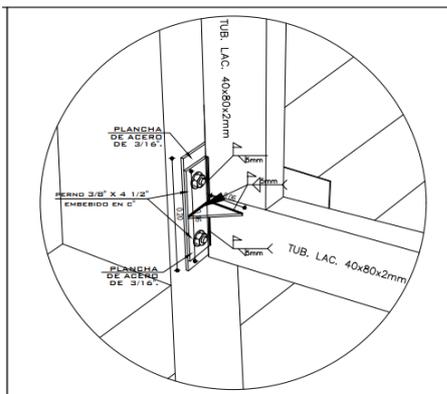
Detalle de anclaje de cercha metálica contra elemento de concreto armado
